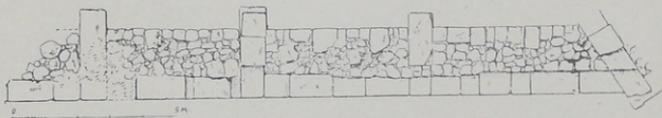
Prospetto della torre A con muraglione di fianco.
